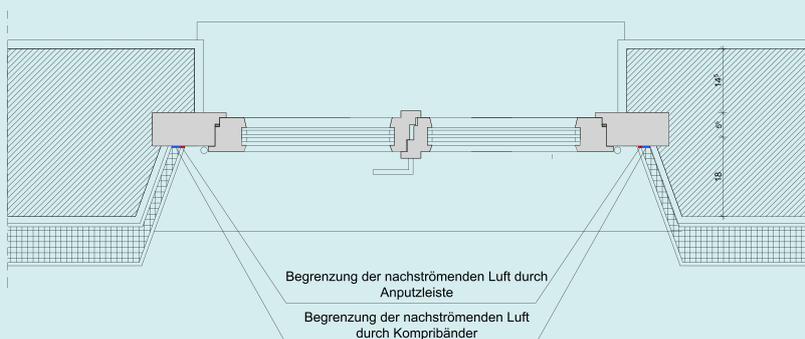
Grundriss Fenster Sanierungsvariante Doppelfenster
